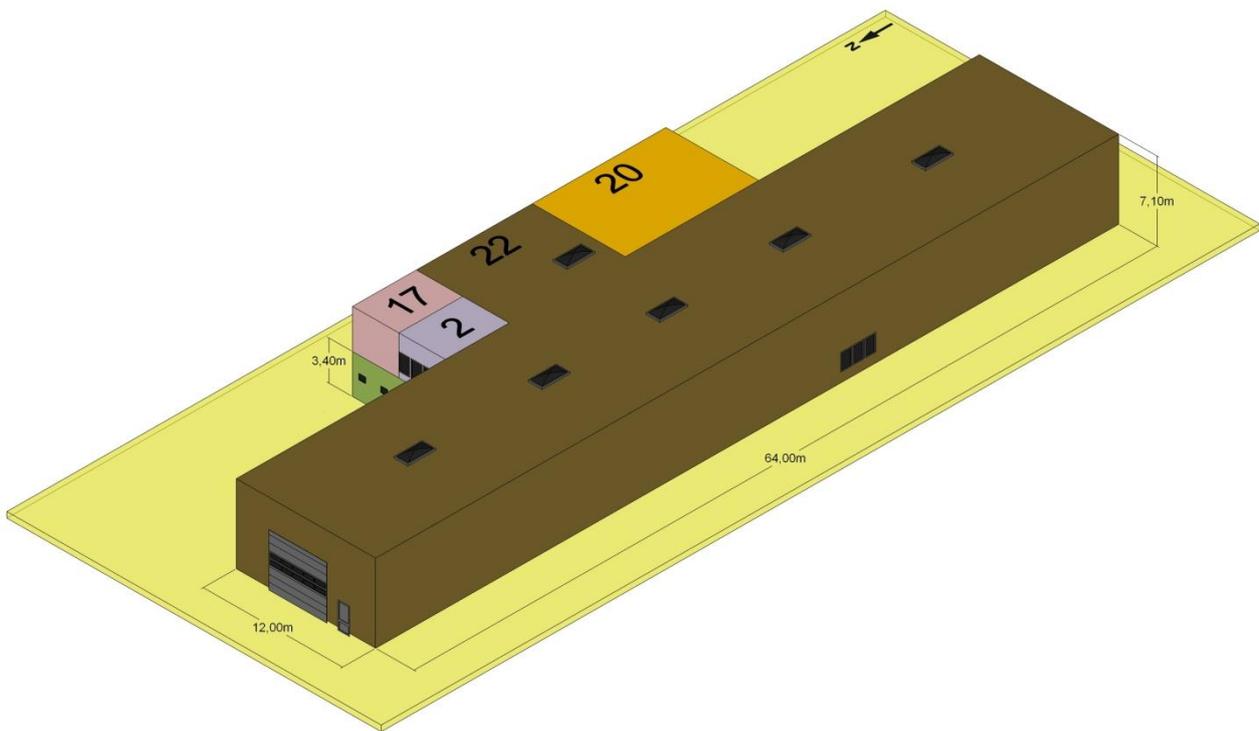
Produktionshallen - klein - Darstellung Zonen - Ansicht Nord-West
